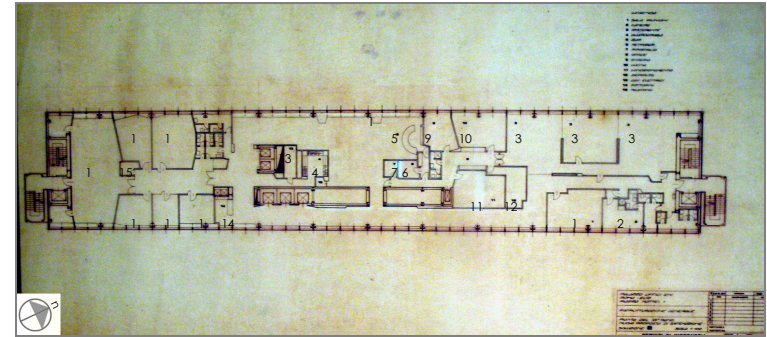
proposta di ristrutturazione generale – pianta piano 19° – soluzione a (fonte CSAC , stralcio tav. 75, archivio n. 70-1, rielaborazione f.m.)
